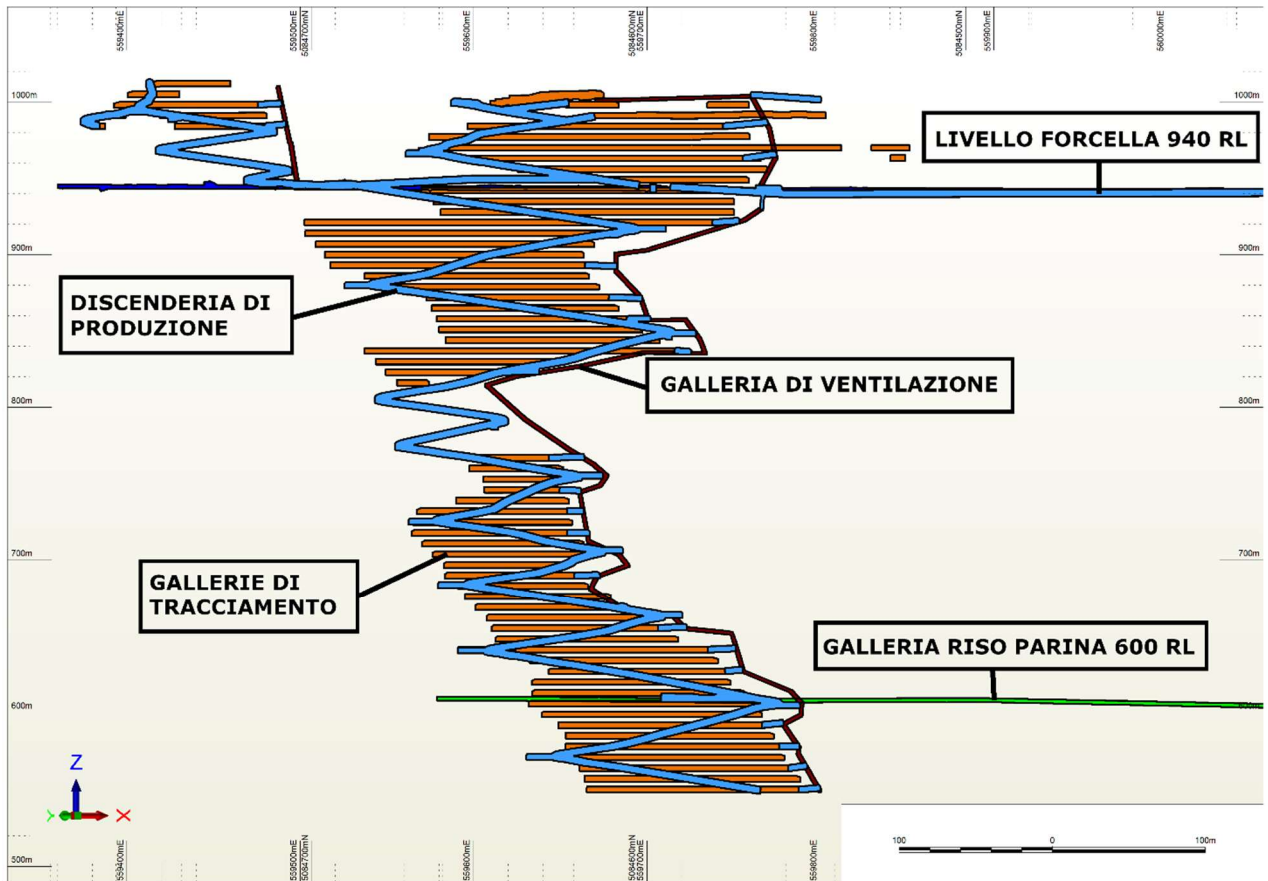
Schema in sezione della miniera, con le principali strutture
